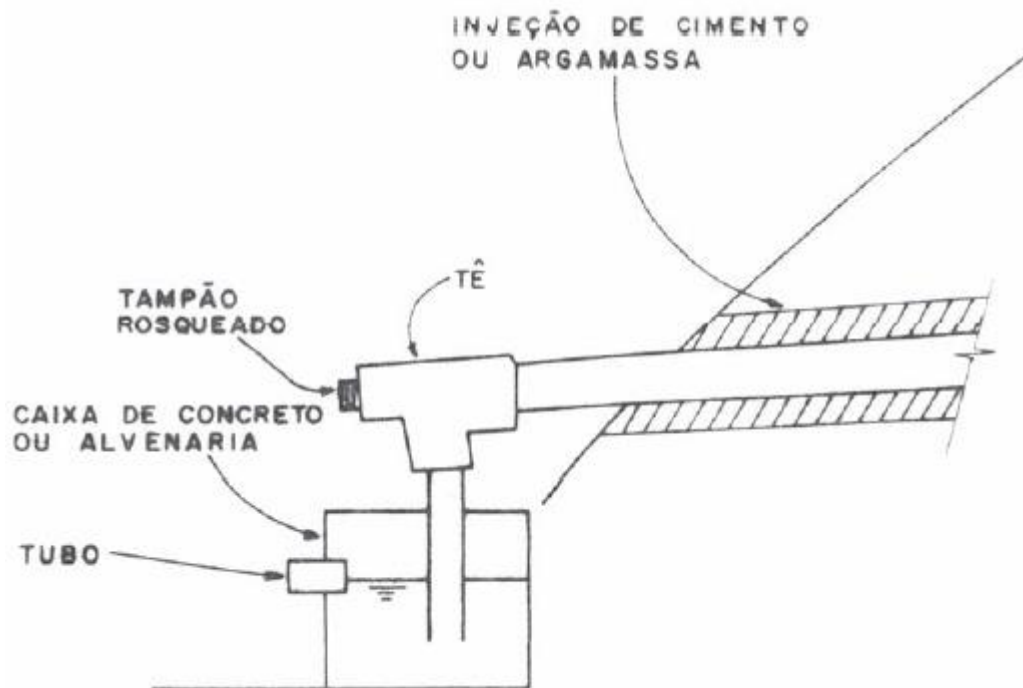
Dreno Sub-Horizontal - Detalhe
